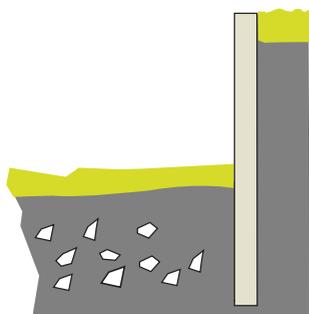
Principe des ouvrages constitués de parois en béton armé
